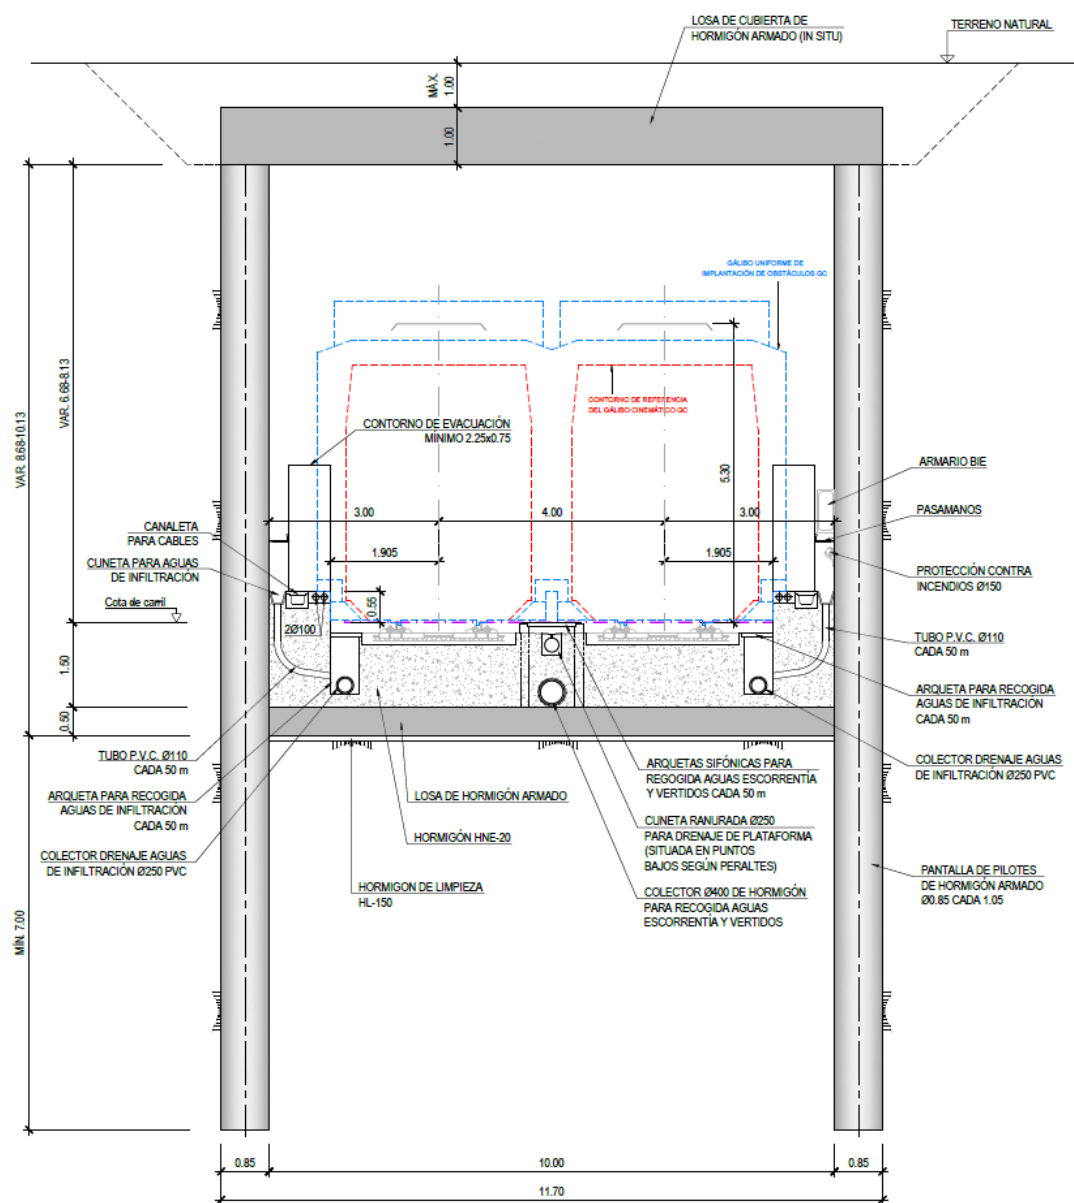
a.- Sección tipo 1 en el tramo soterrado (ST-S1).
